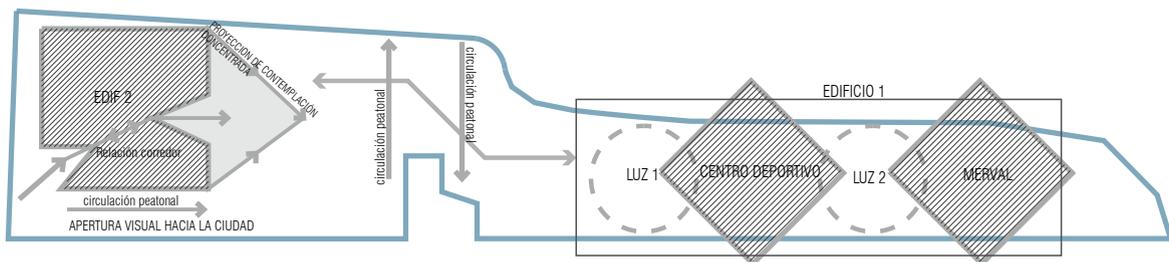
ESQUEMA PLANTEAMIENTO INICIAL PROYECTO
